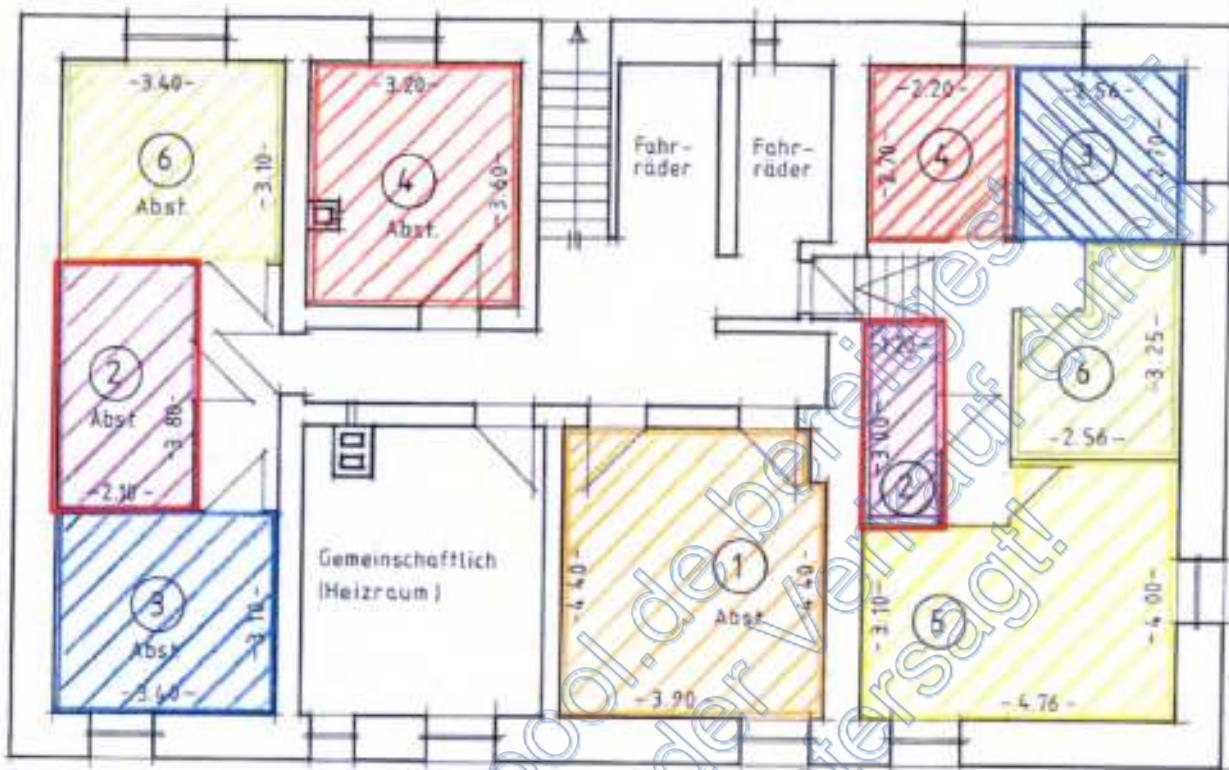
Grundriss KG (ohne Maßstab); Quelle: Teilungspläne aus der Teilungserklärung UR Nr. 1034/1989 vom 20.12.1989, Grundakte zu Grundbuch Blatt 20607, Roteintragung d.d. SV; Abstellraum Nr. 2 und Sondernutzungsrecht Kellerraum Nr. 2
